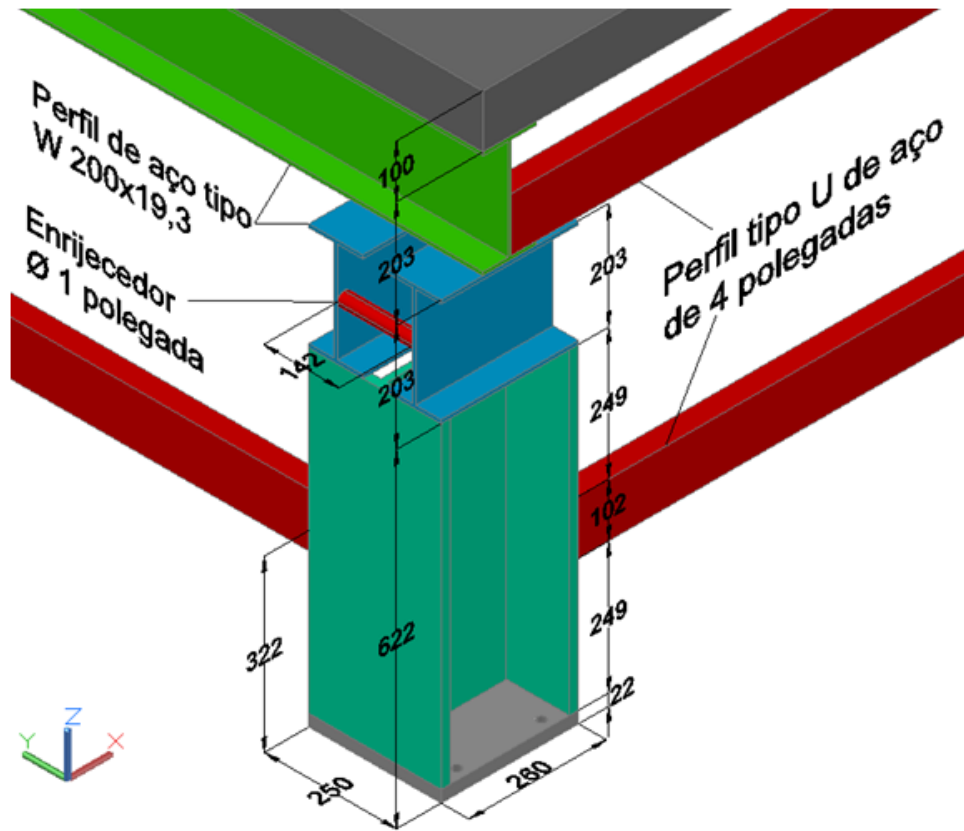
Detalhamento das medidas dos perfis, pilar e laje. Medidas em mm.
